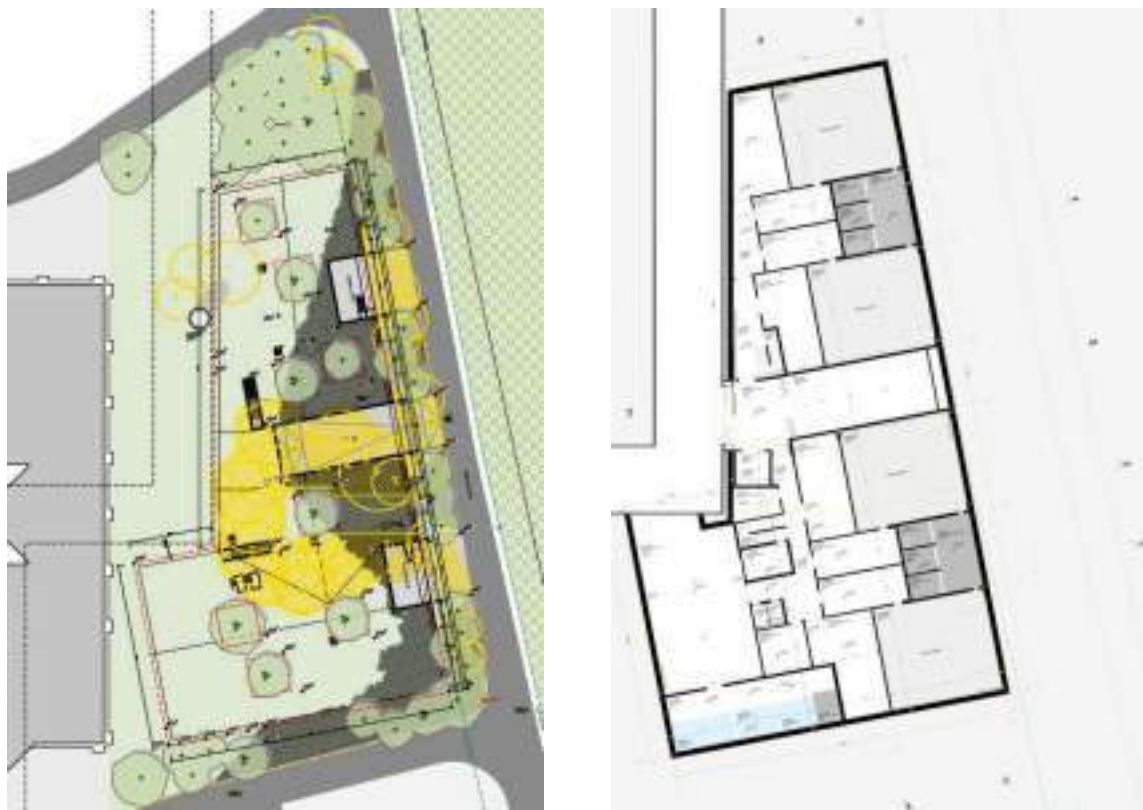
Extraits plan d'aménagements extérieurs et plan du 1^{er} sous-sol
